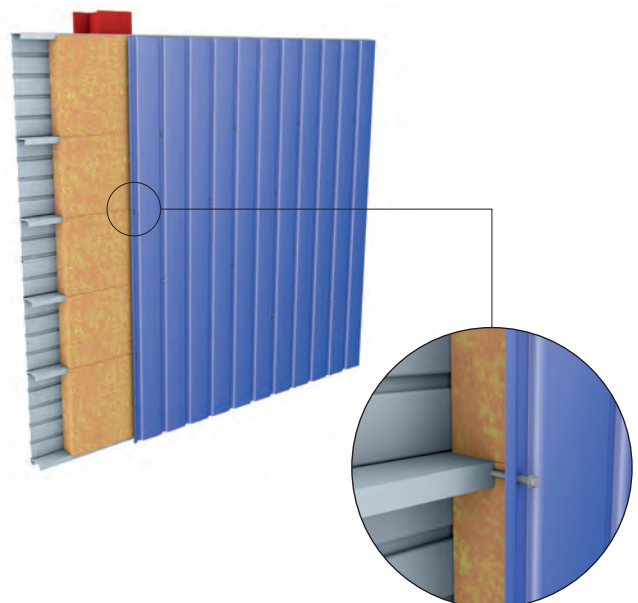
Illustration de la pose d'un bardage sur plateaux métalliques avec vis entretoise (bardage non traditionnel)
